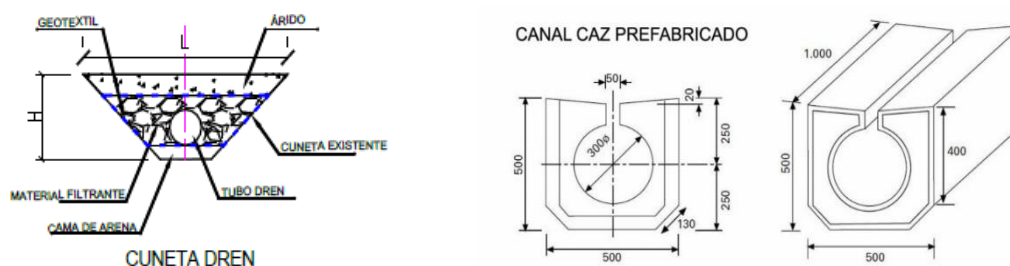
Tipos de drenaje longitudinal. Fuente: Elaboración propia.
